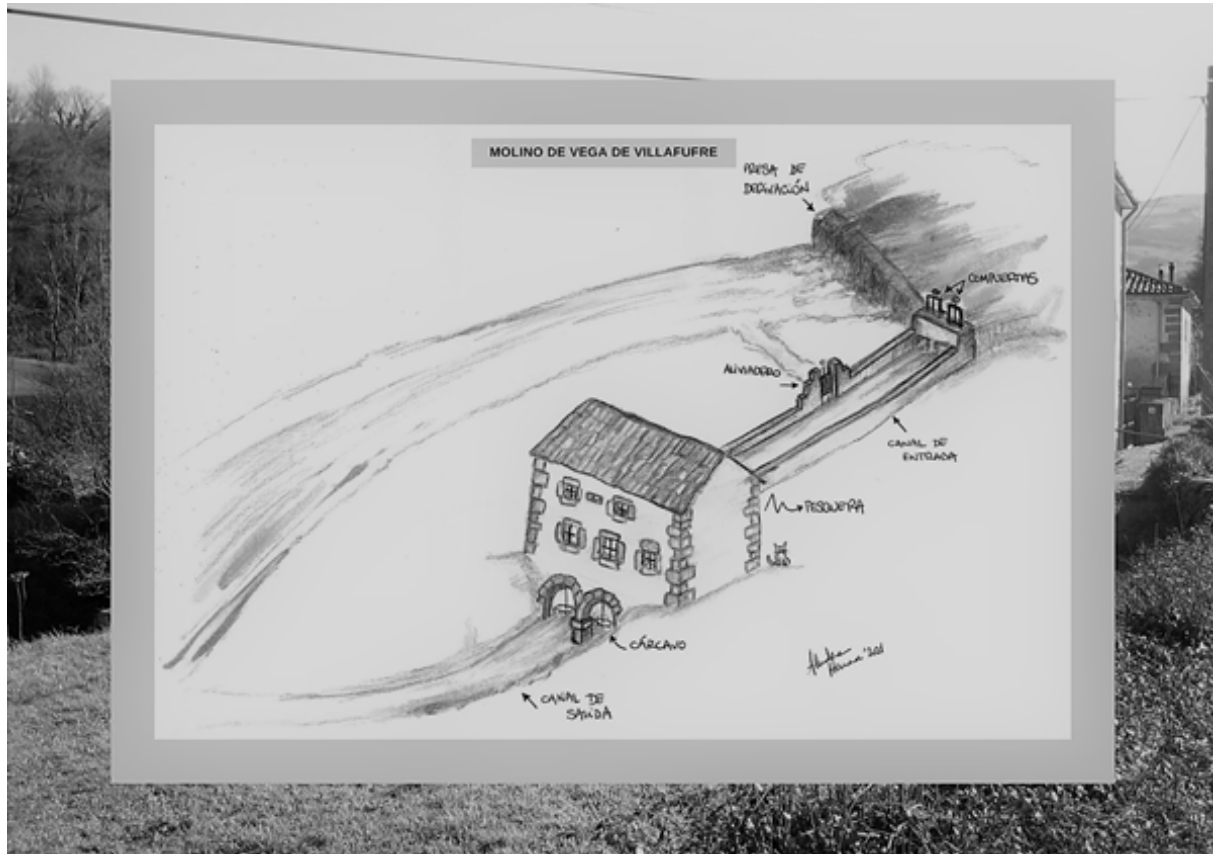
Croquis sobre las infraestructuras hidráulicas asociadas a La Molina. Elaboración propia
